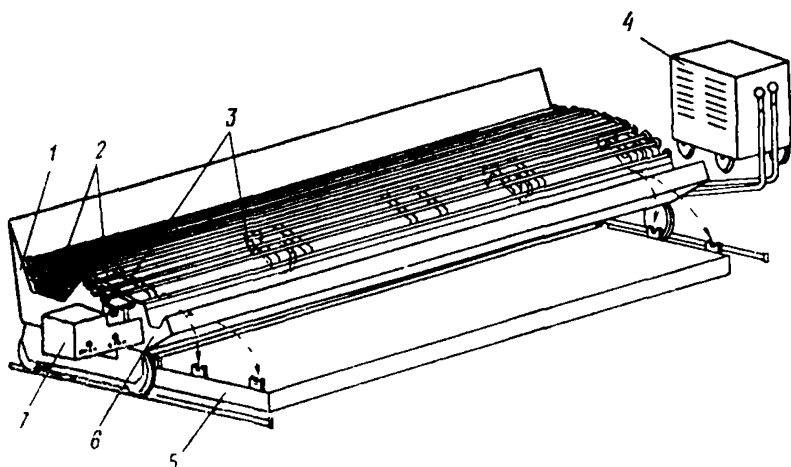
Схема полуавтоматической универсальной нагревательной установки УНУ-1 (конструкция ВНИИЖелезобетон)
